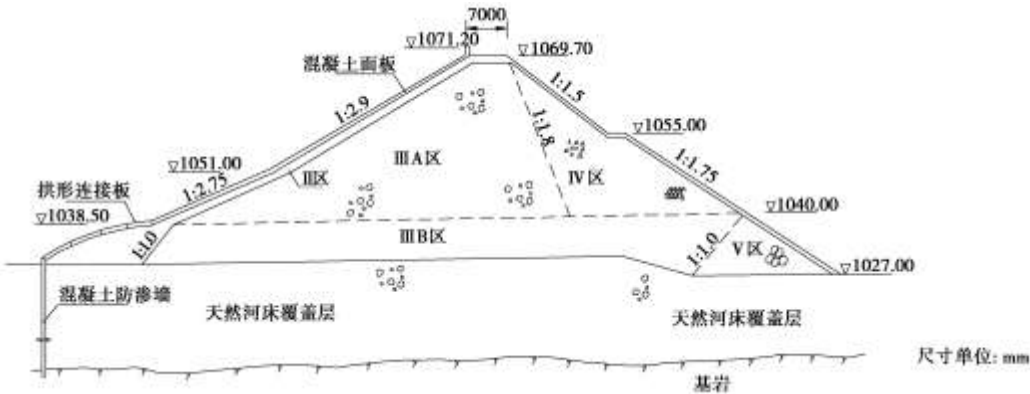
柯柯亚水库混凝土面板砂砾石坝典型剖面图
